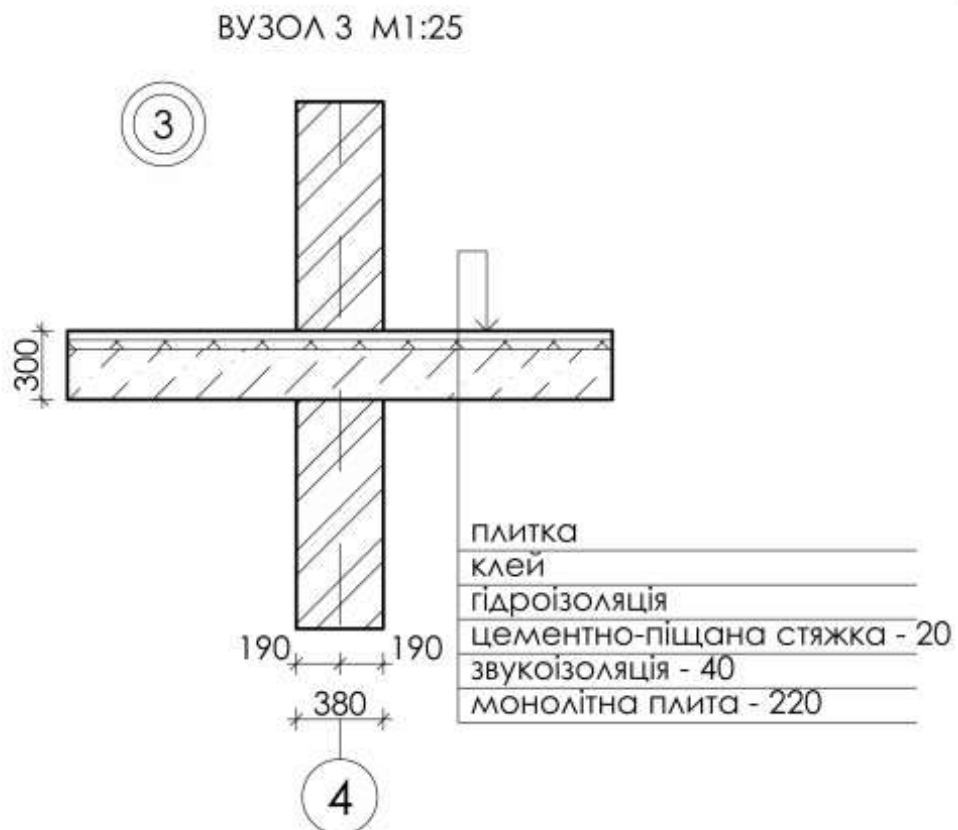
Конструктивний вузол міжповерхового перекриття №3
